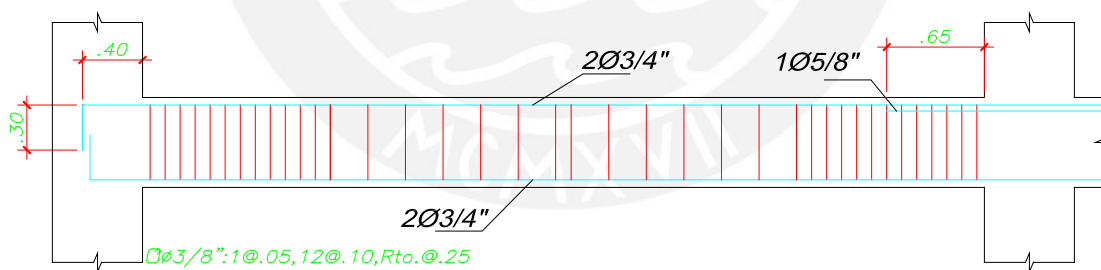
Esquema de refuerzo por cortante de Viga V1-1.
